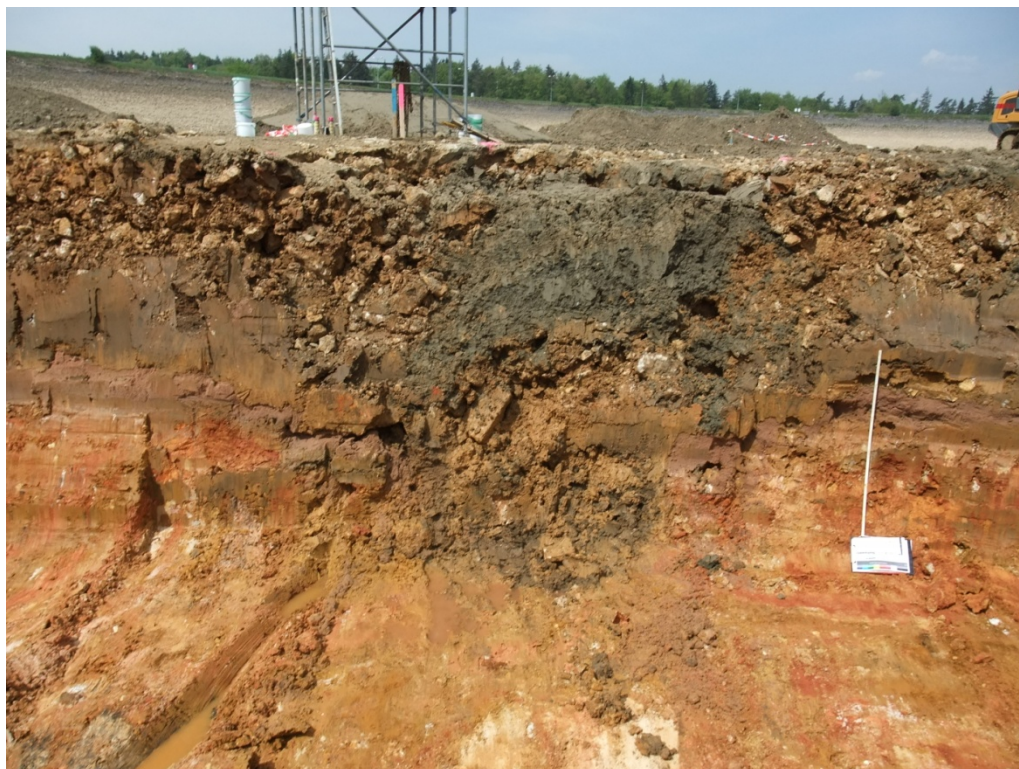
Aushub -2,3 m, Ansicht Einbruchtrichter 17 im Anschnitt
